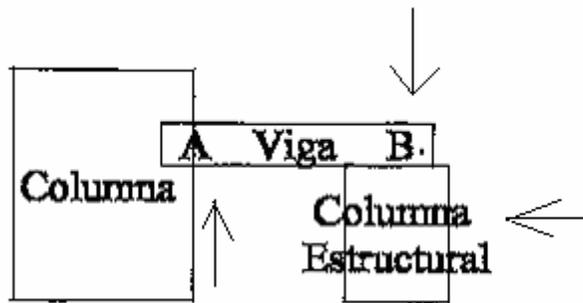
Las Columnas Estructurales – Reporte del ISD (p. 16)
